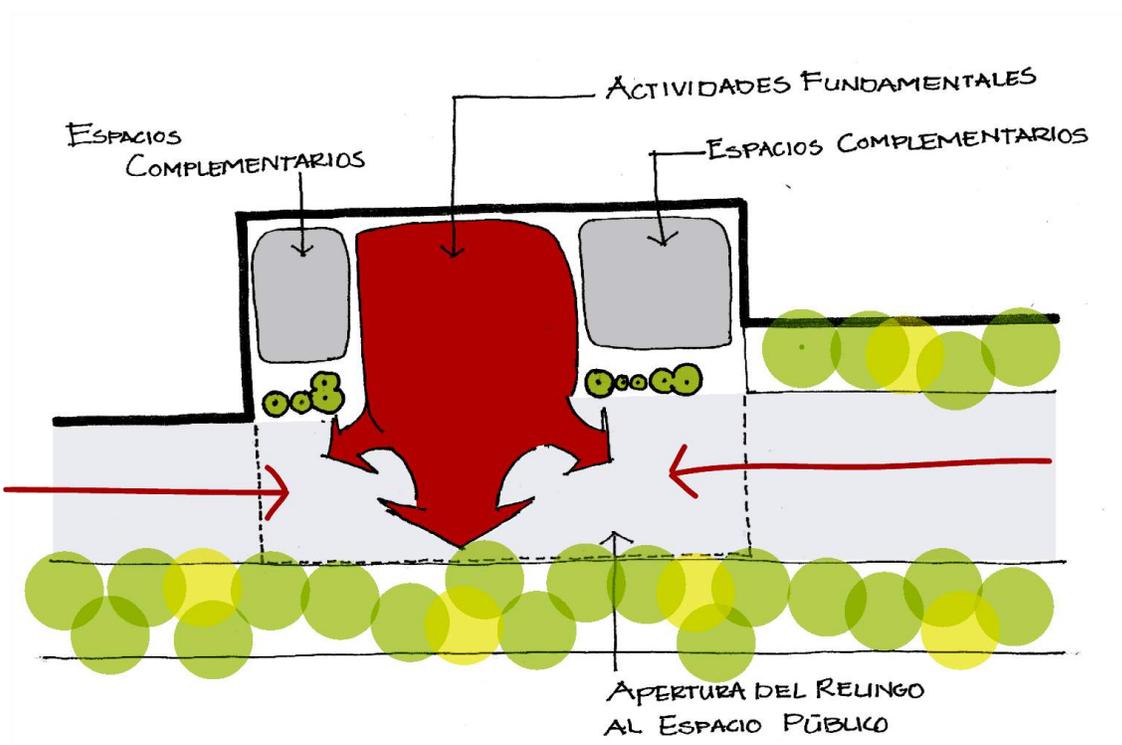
Primer acercamiento de actividades y espacios en el Relingo. Planta Baja
